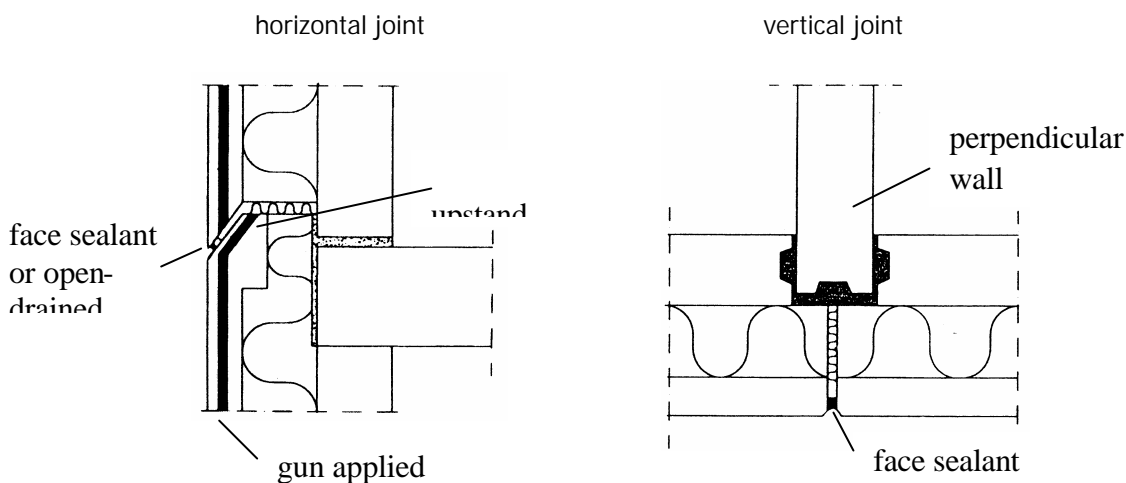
Configuração típica para juntas em painéis tipo sanduiche para fachadas
